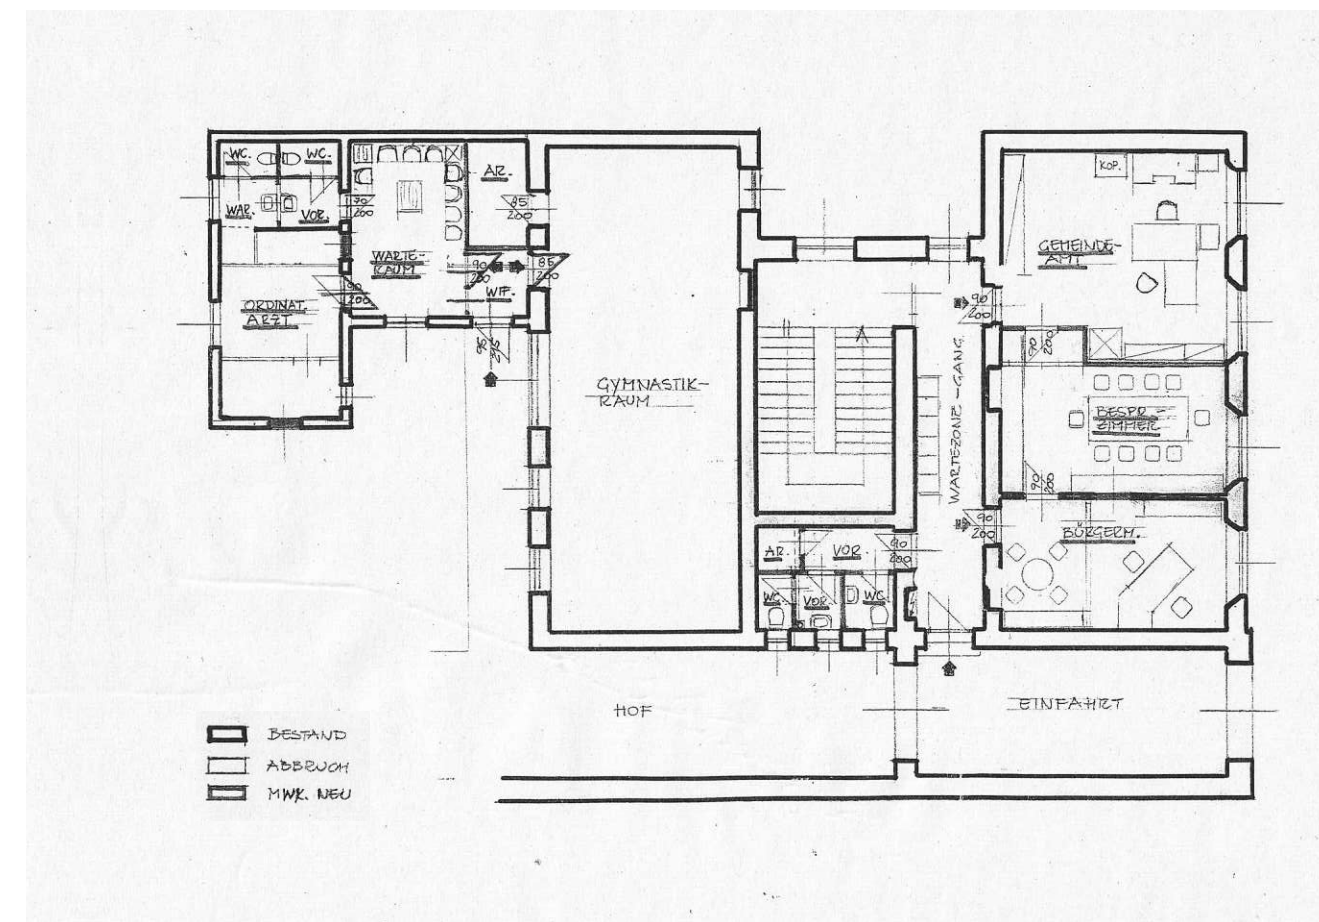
Grundriss Erdgeschoß Bestand 1:200
